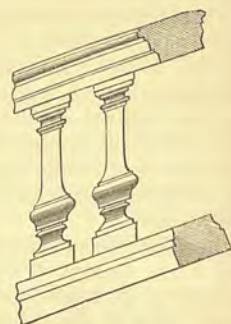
Parapetto scalone palazzo Accademia Filarmonica a Torino.
